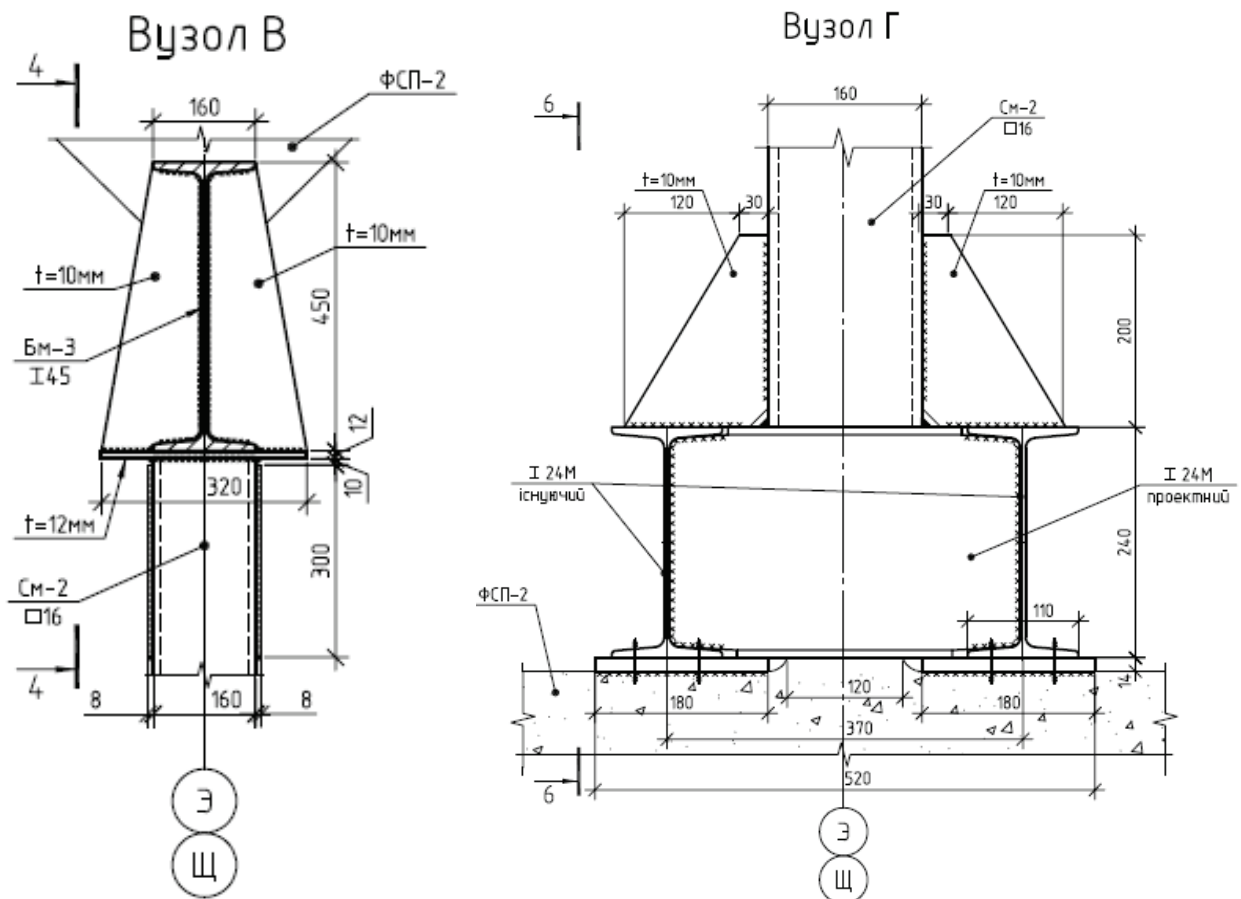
Вузли обпирання на ферму конструкцій рами під крани для монтажу лінії R-7
